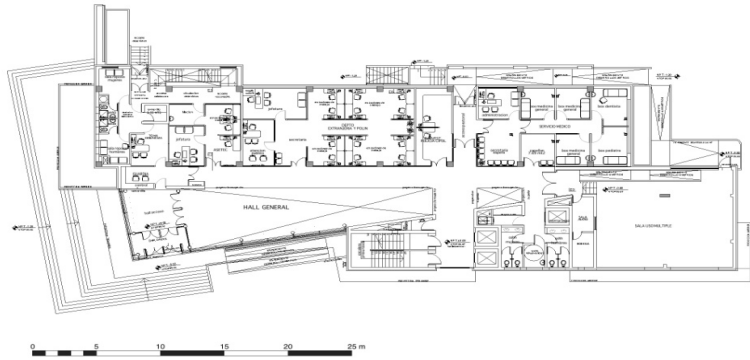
Planta Piso 1 – Acceso – Nivel 0,00
